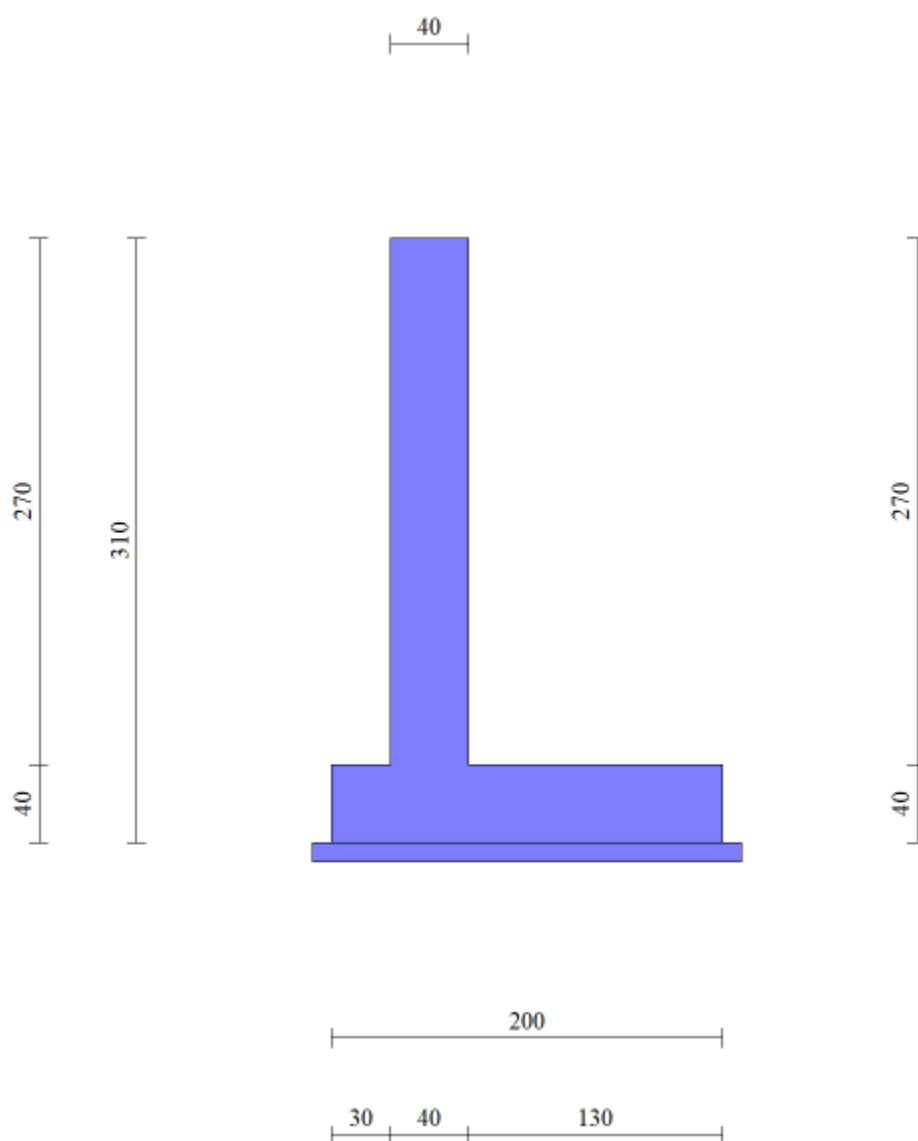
Estratto dal software di calcolo MAX 16.0 – Geometria di modellazione in sezione – intervento 9.
